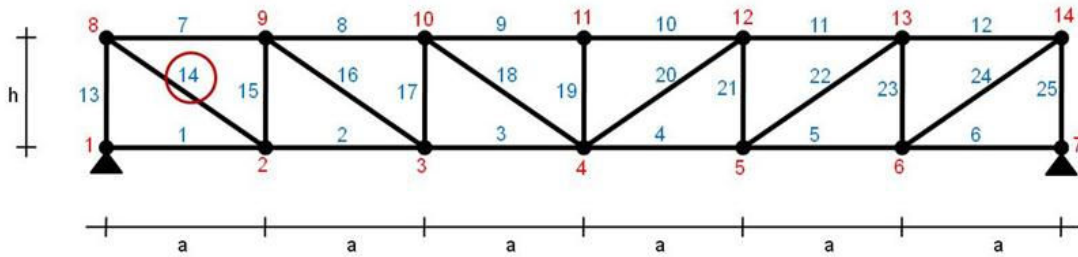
Elemento da diagonal com aplicação do dano.
